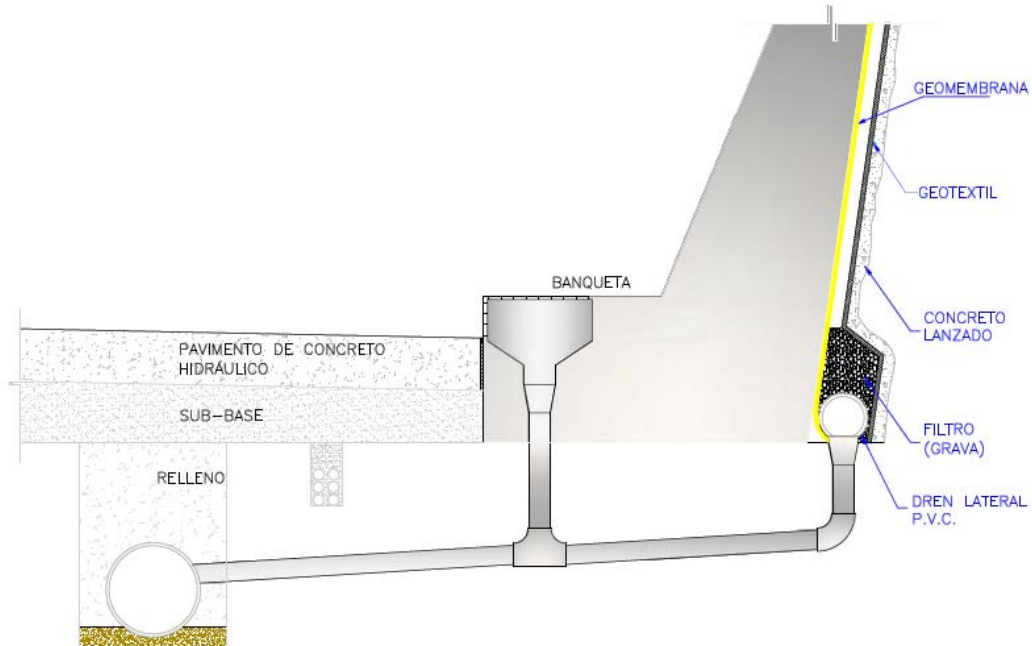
Detalle de la impermeabilización y del drenaje de un túnel. (López, 1999).
